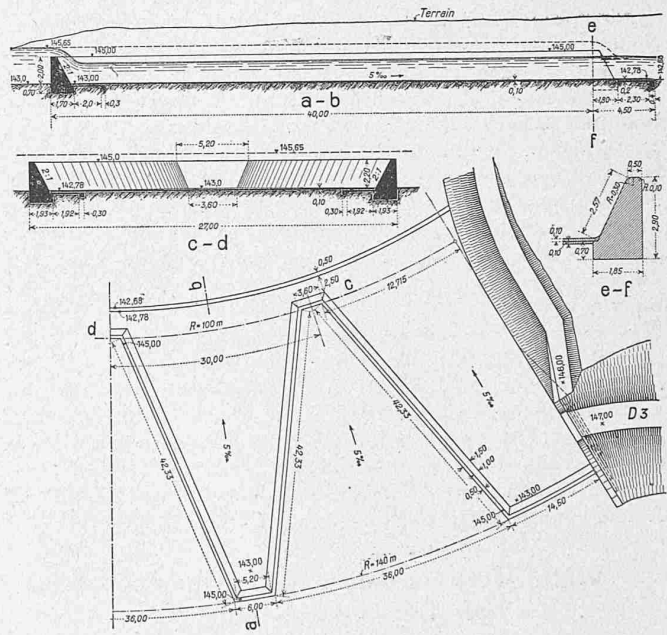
Ueberlauf-Grundriss 1:1000, Schnitte a-b und c-d 1:500, e-f 1:250.
